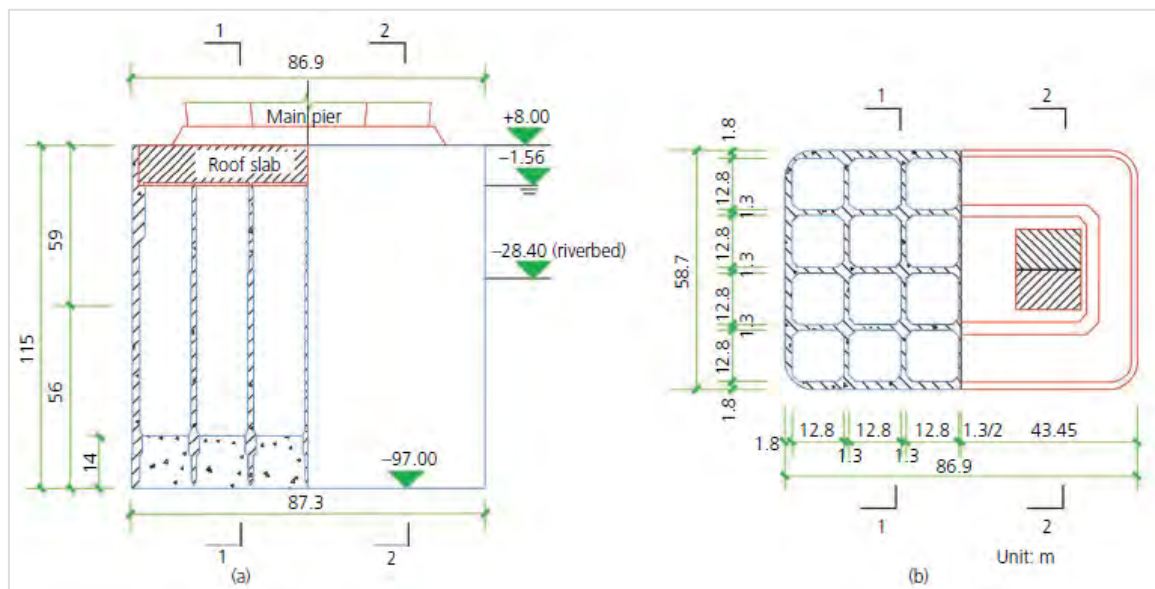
Hutong Yangtze River Bridge – Tipica fondazione a cassone aperto
